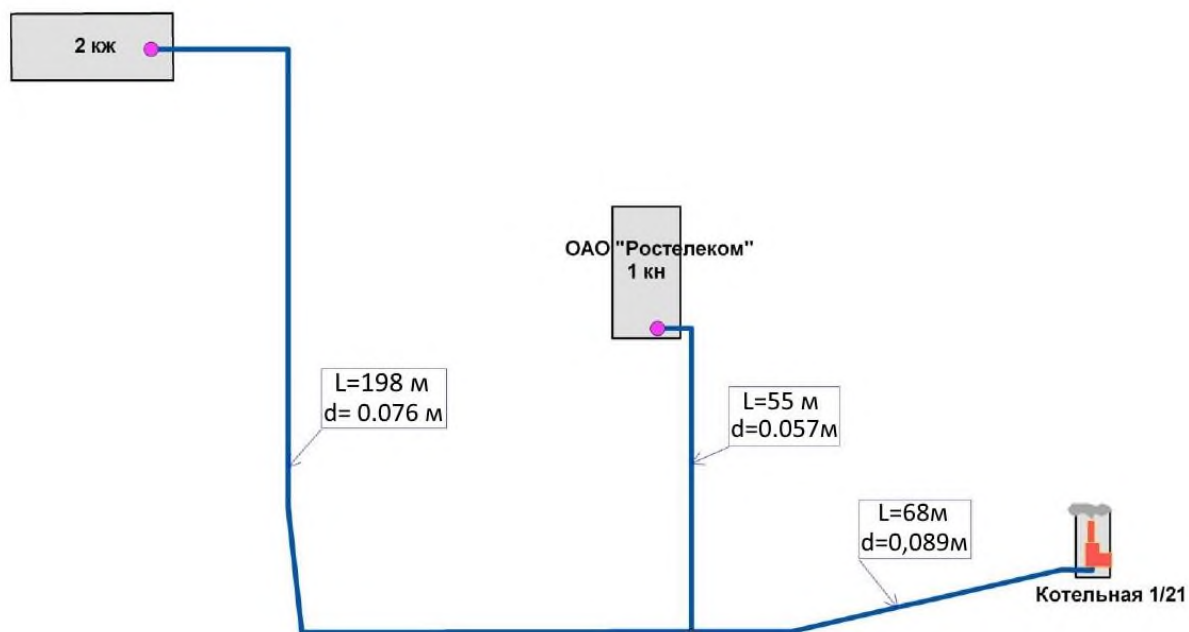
Схема теплоснабжения котельной АМК №1/21
